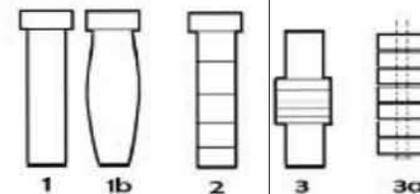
Tipos de columnas según su forma de trabajo y técnica de estructuración:
